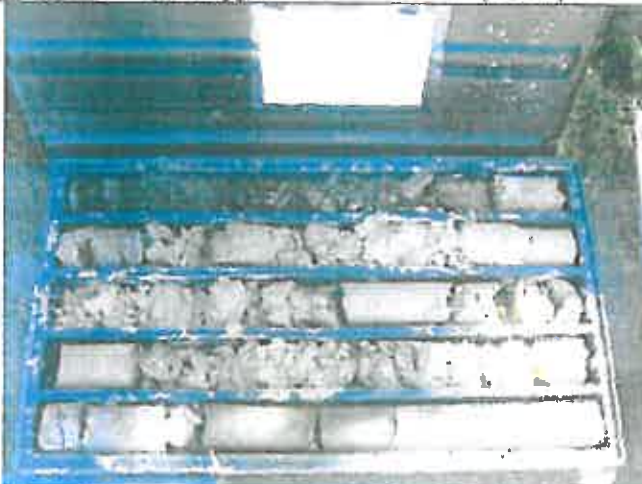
Sondaggio PG6 Cassetta 1 (0-5 m)
